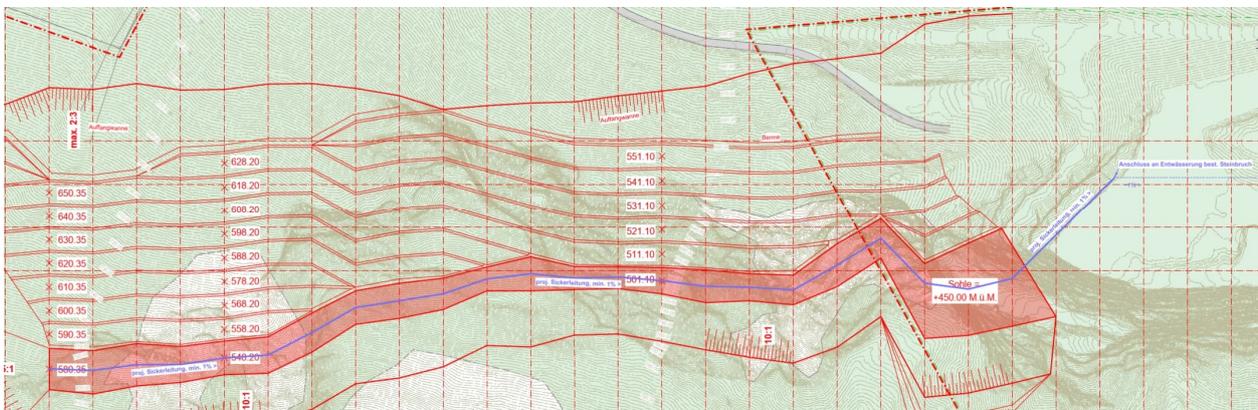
Ausschnitt Situation Entwässerung: Projektierte Sickerleitung mit Anschluss an das bestehende Retentionsbecken
